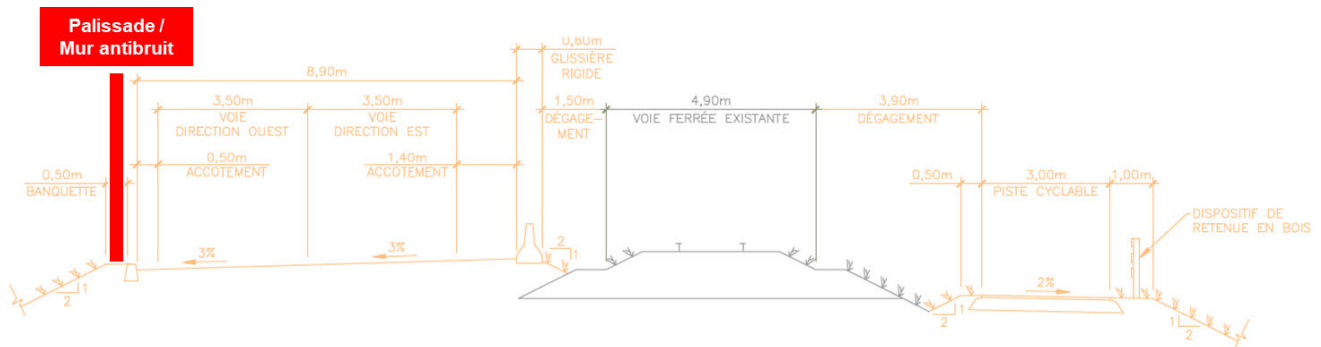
Coupe type avec l'ajout d'une palissade / mur antibruit
